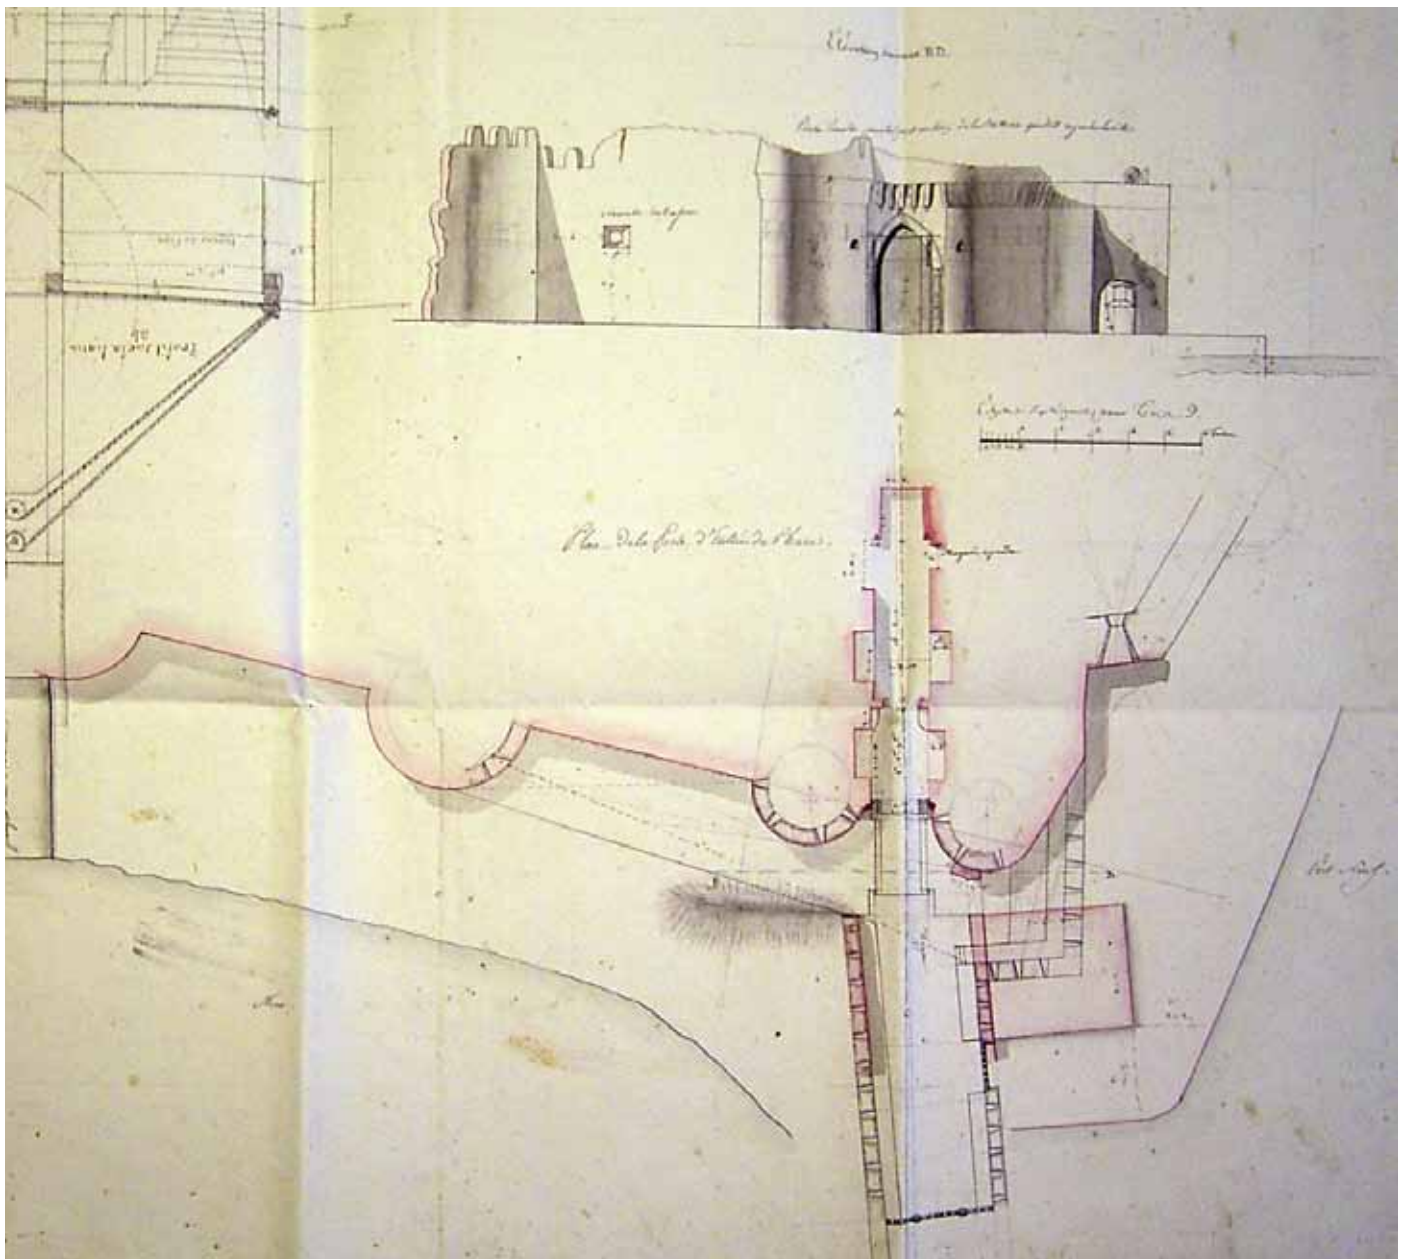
Der Torbau vor dem Umbau: Grundriss und Ansicht, 1800 (SHAT - 1VM2, Nr. 22).
